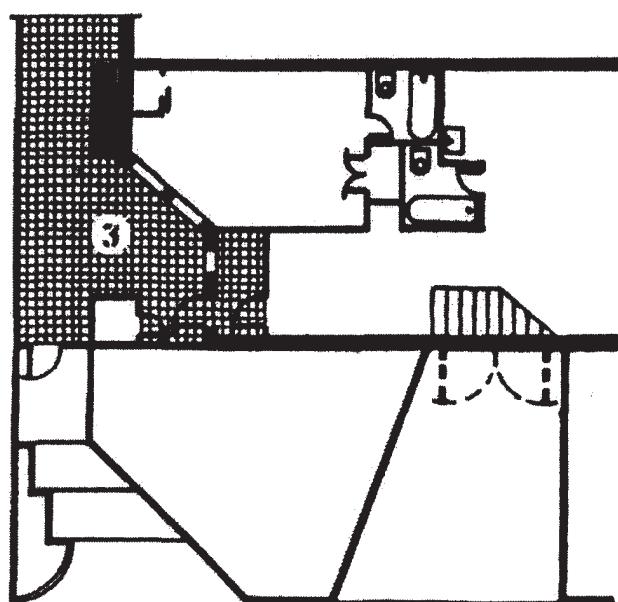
Планировочные схемы входных узлов малоэтажных жилых зданий
